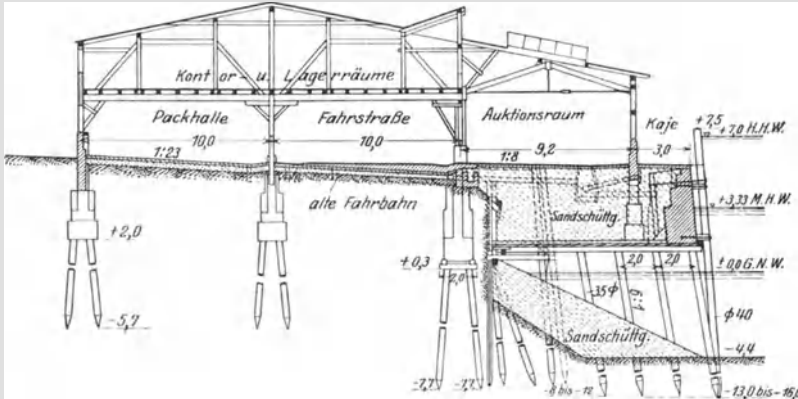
Geestemünde. Querschnitt Fischereihafen, Auktionshalle und Packhalle und der Umbauzustand vor dem Umbau ist einpunktirt. Maßstab 1 : 400.
